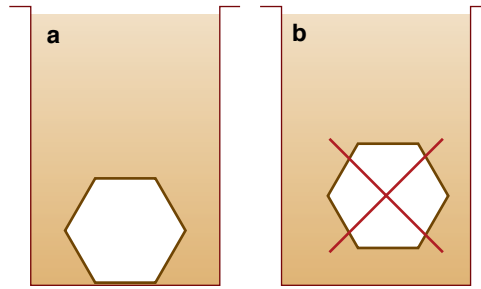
Disposition d'un drain tunnel (coupe transversale)
